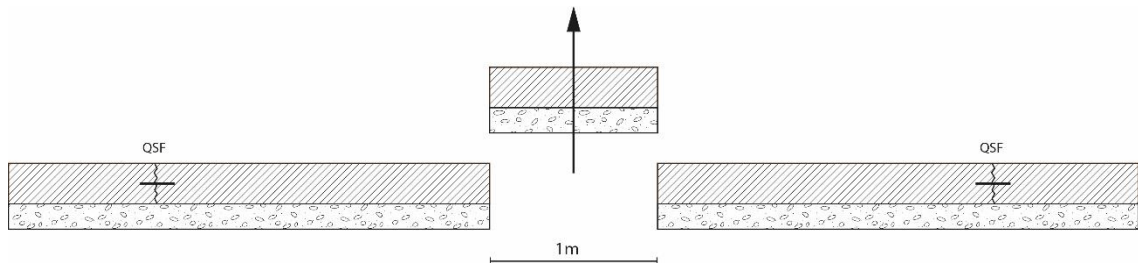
Fall 2 - Herausschneiden eines ca. 1 m breiten Streifens der Betondecke mit HGT in Plattenmitte und anschließender Asphaltersatz
